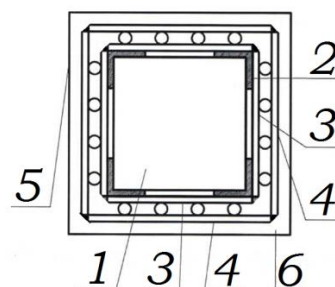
Вариант усиления колонны: 1 - усиливаемая колонна; 2 - уголок; 3- термопланка; 4 - каркас К-1; 5 - торкретбетон В30; 6 - сварка поперечной арматуры каркасов
